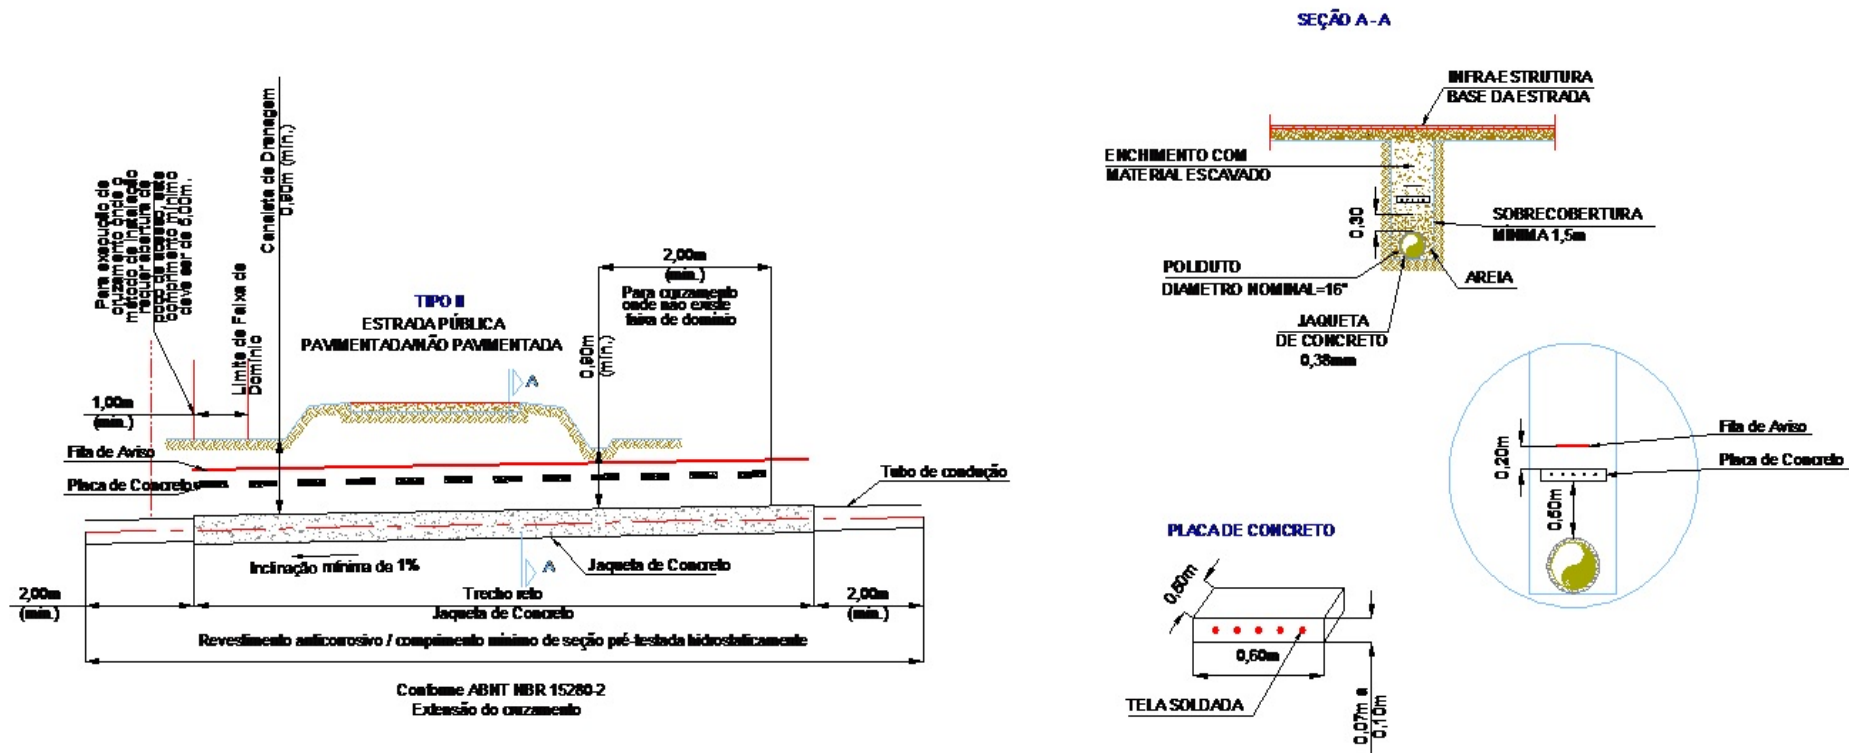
Detalhe Típico Cruzamento – Estrada Pavimentada / Não Pavimentada (Abertura de Vala).
